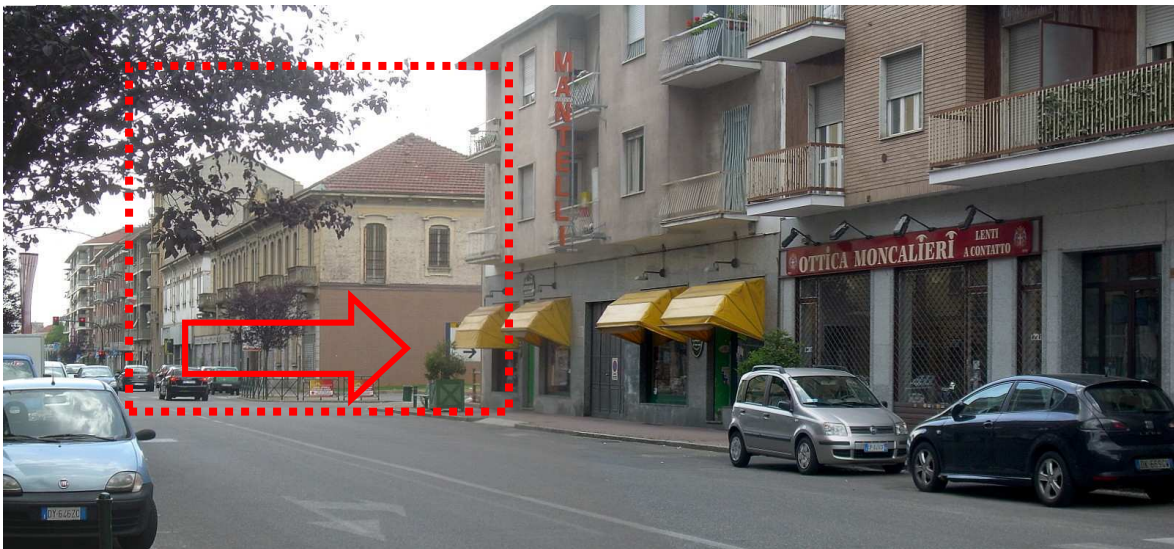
/II - Vista dell'affaccio su Via Sestriere e degli edifici oggetto di demolizione
